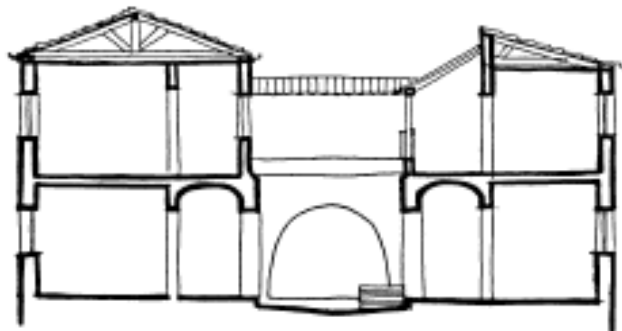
Coupe sur le bâtiment à l'entrée de la Casbah de Bejaia
